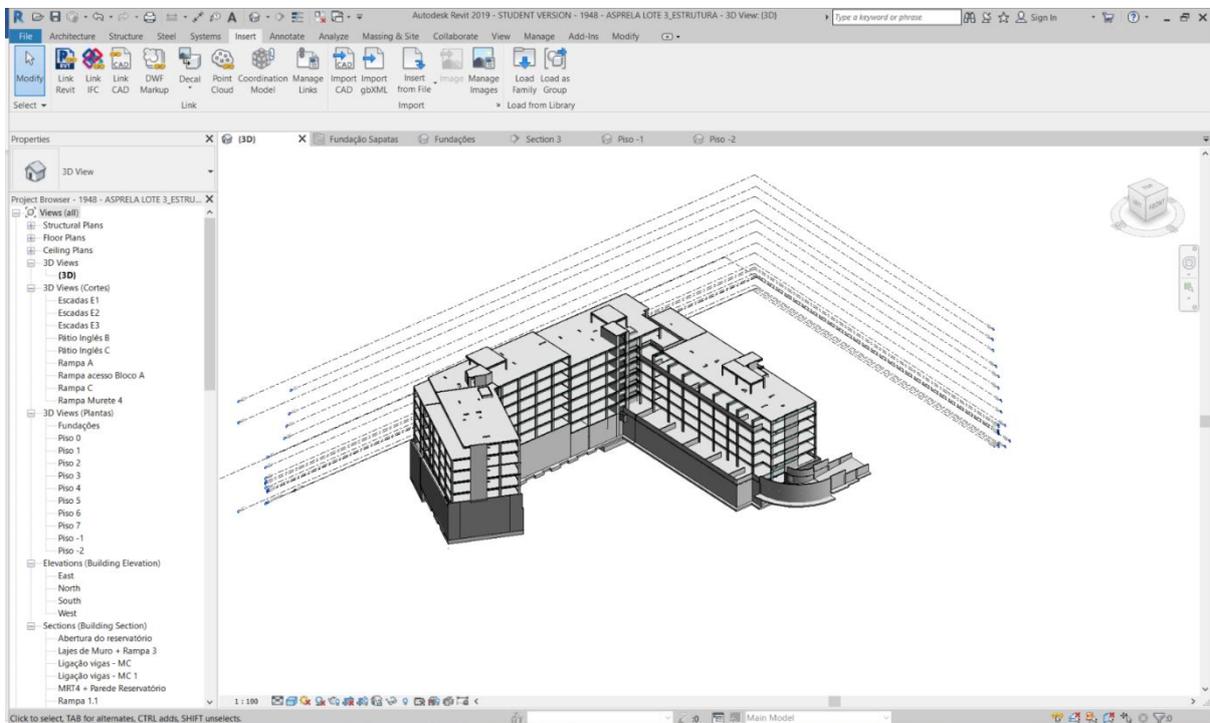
Modelação da Estrutura e Fundações (autor).
